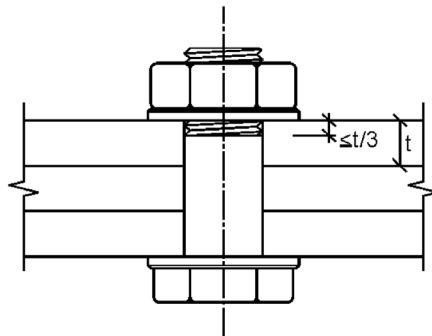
Ins Schraubenloch hineinragendes Gewinde einer Passschraube /4/
